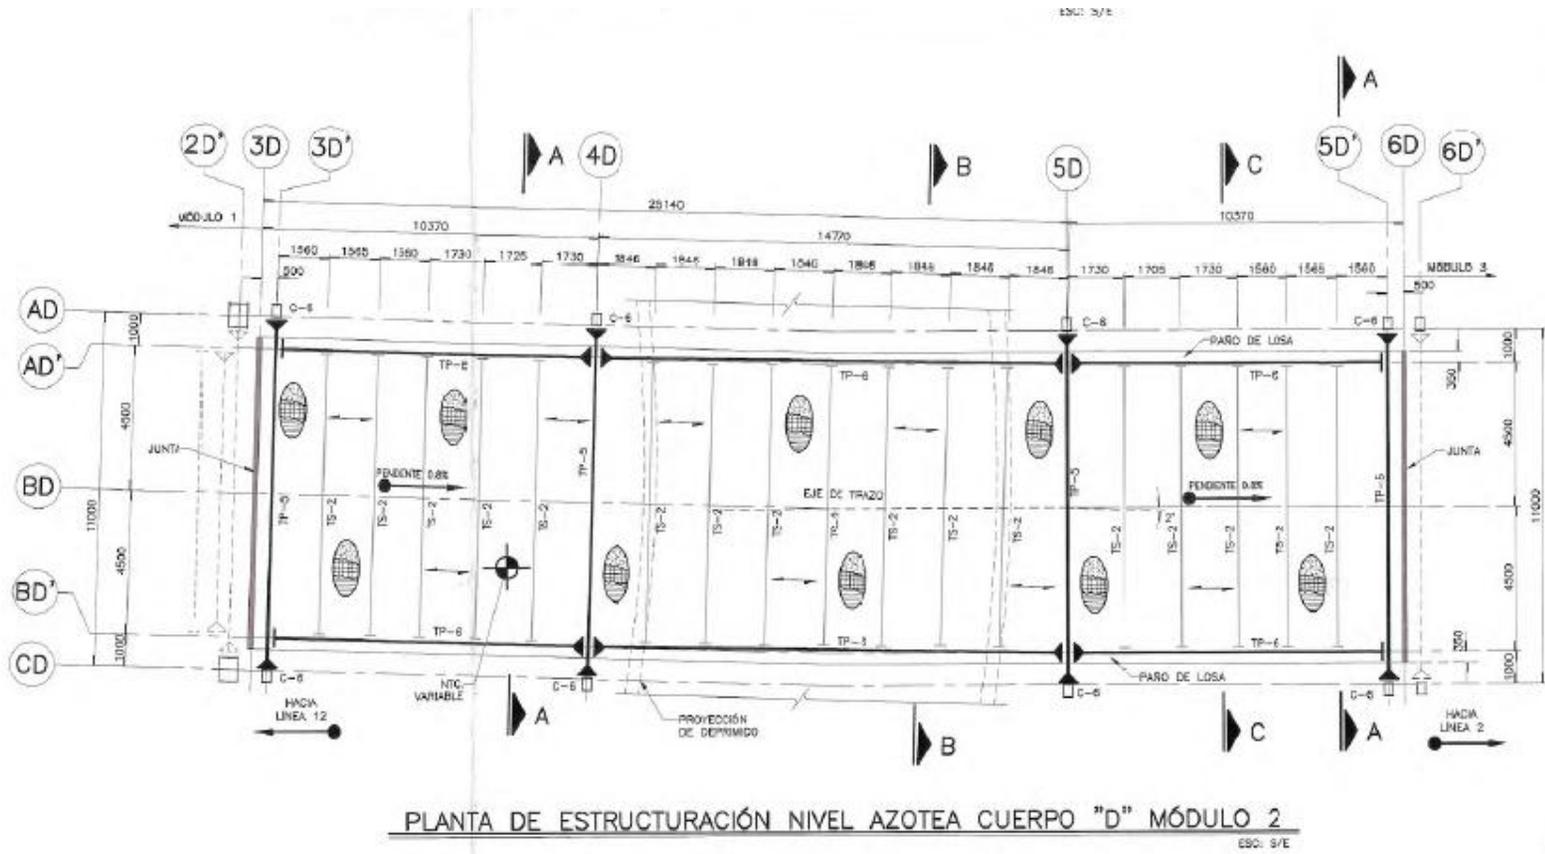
Planta de estructuración nivel azotea, módulo 2.
